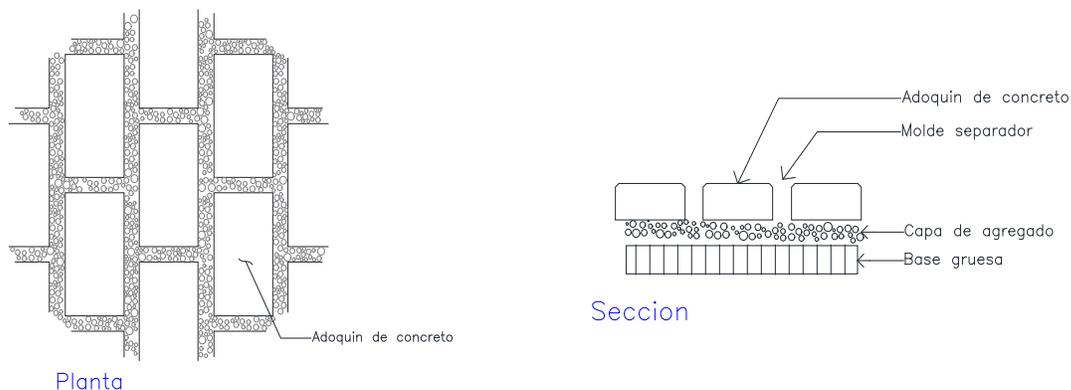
Detalle del adoquín de concreto en planta y sección
